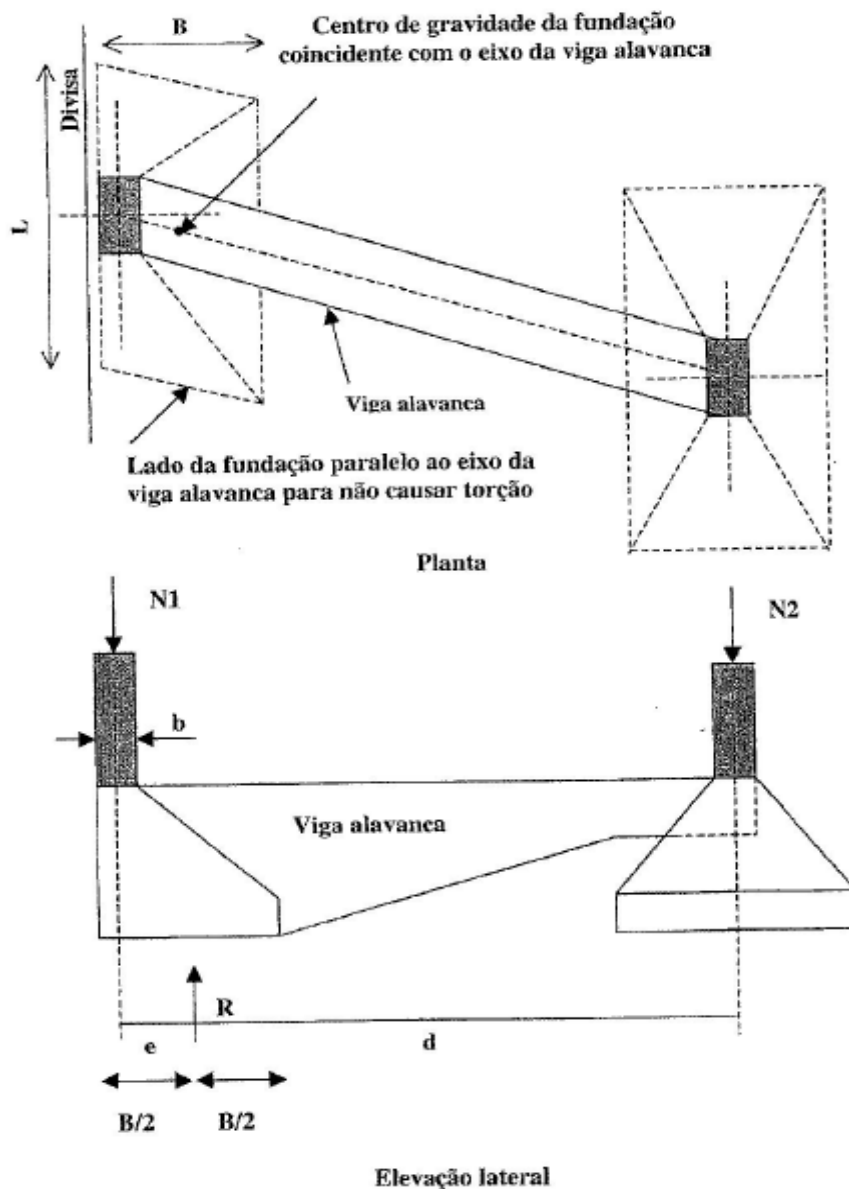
Pilar junto à divisa com viga alavanca – solução típica
